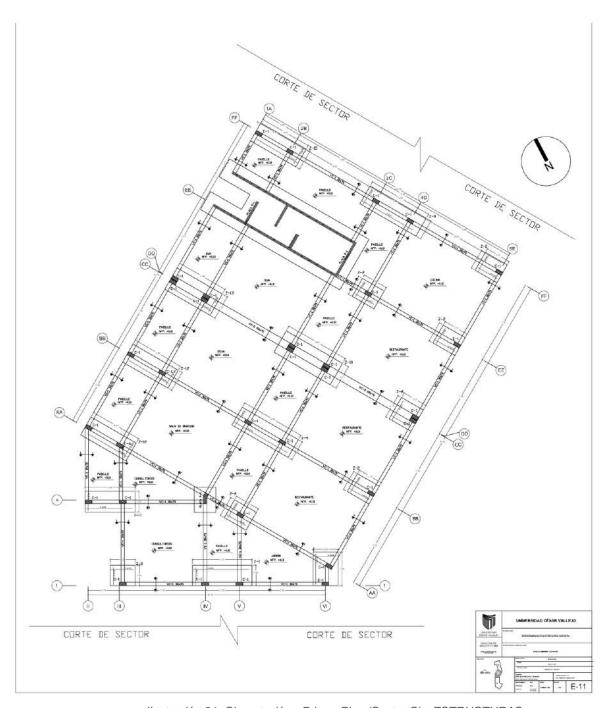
Cimentación - Primer Piso (Sector C) - ESTRUCTURAS
